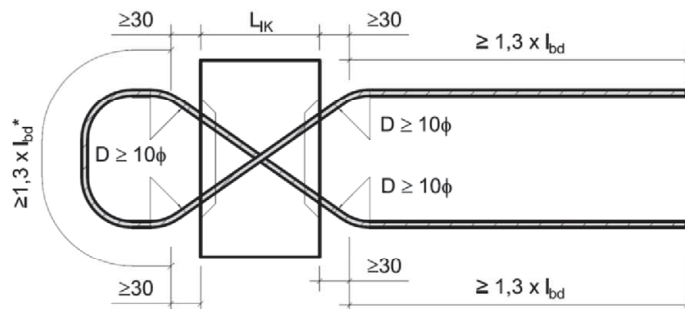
Querkraftstab für Schöck Isokorb® Typ F
